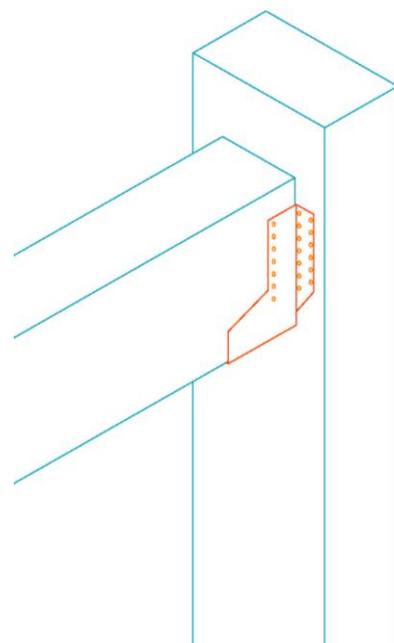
Encuentro entre una viga y un pilar de madera (Dibujo original)
